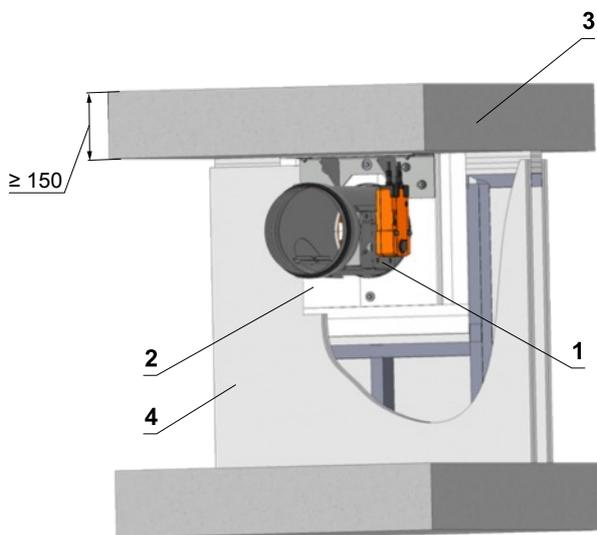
Leichtbauwände - gleitender Deckenanschluss - Trockeneinbau - Einbaurahmen E5, R7
